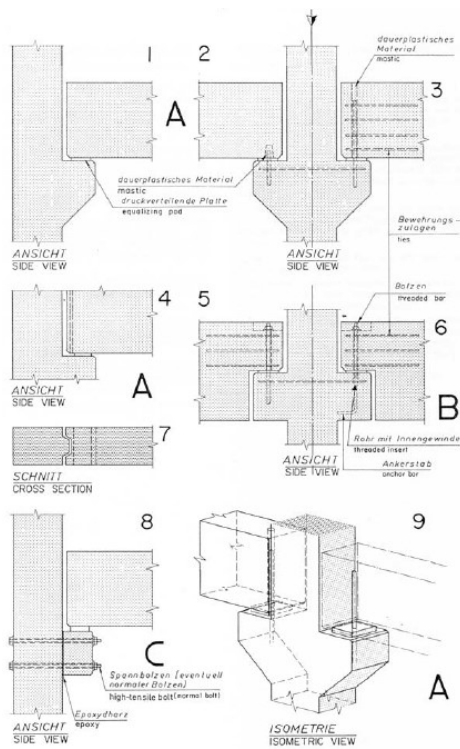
Ligação por consolo de betão (Stupré, 1981)
